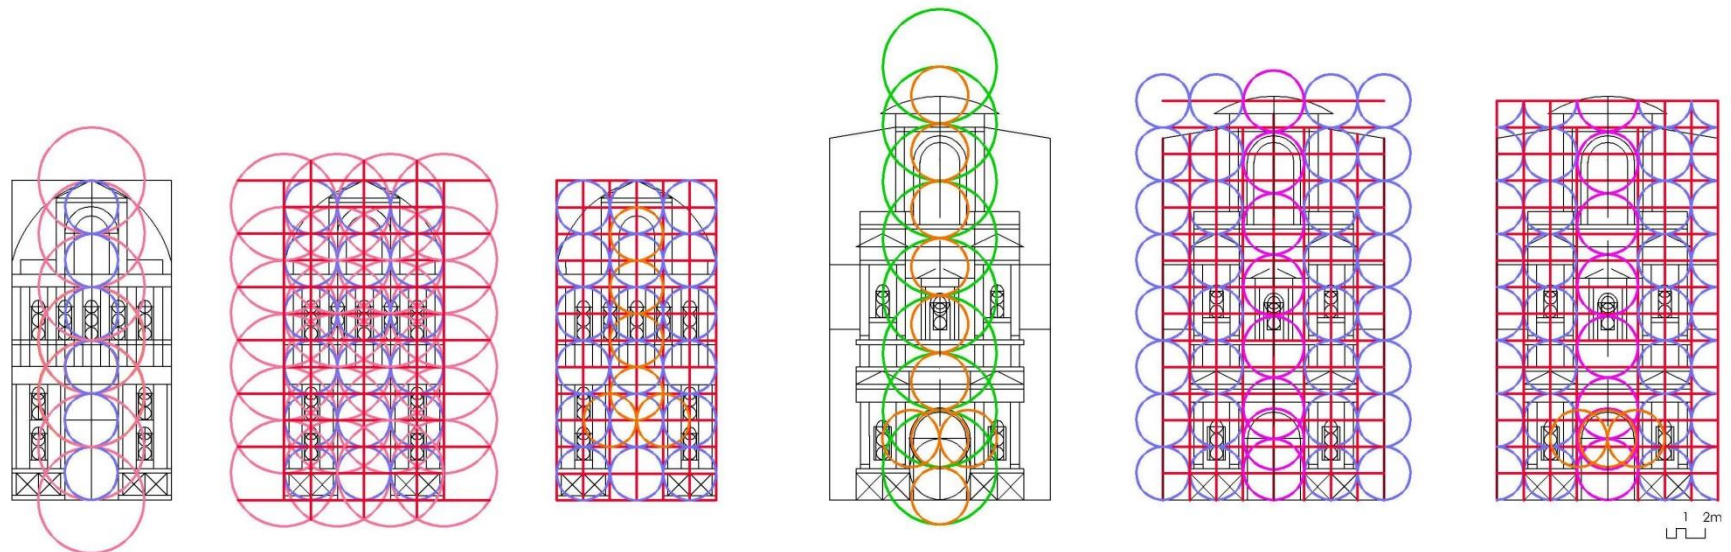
Comparativa desarrollo fachada retablo de Vistabella (Castellón) y Andorra (Teruel).
